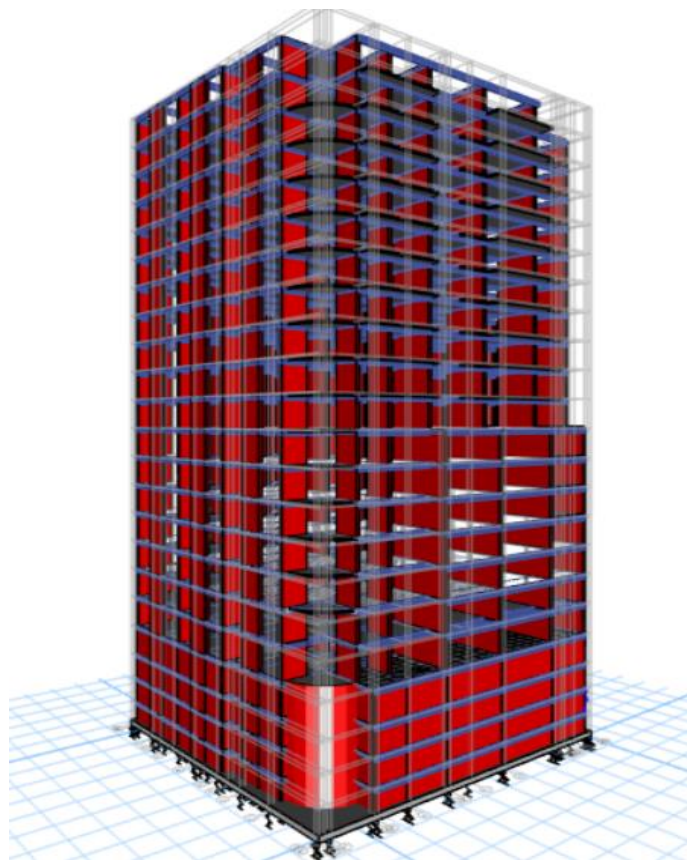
Modèle 3: Superstructure + sous-sols + fondation de Winkler.
